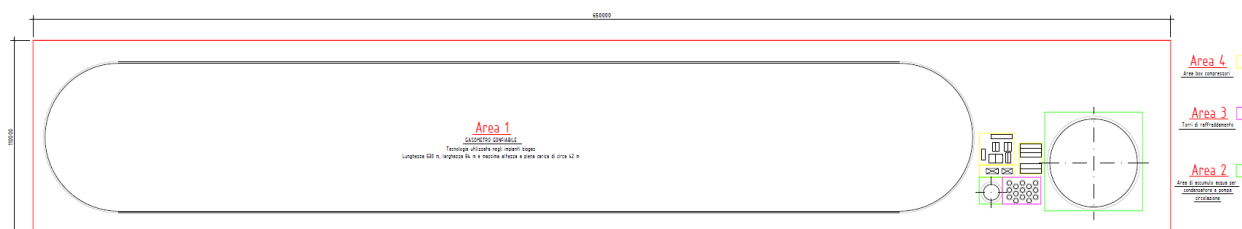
Layout dell'impianto CO2 Battery all'interno del perimetro 650 x110 m
